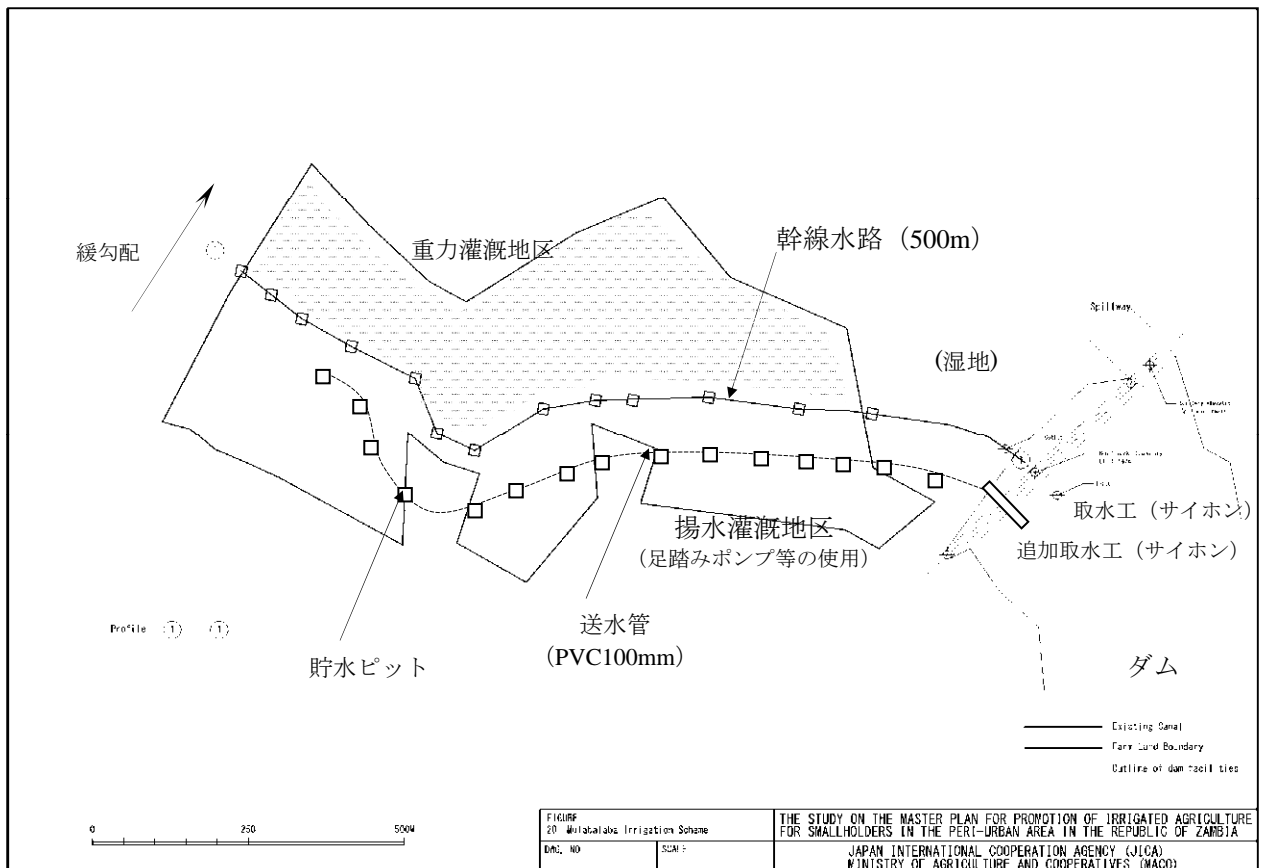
ムラバラバ灌漑スキーム灌漑施設配置図
